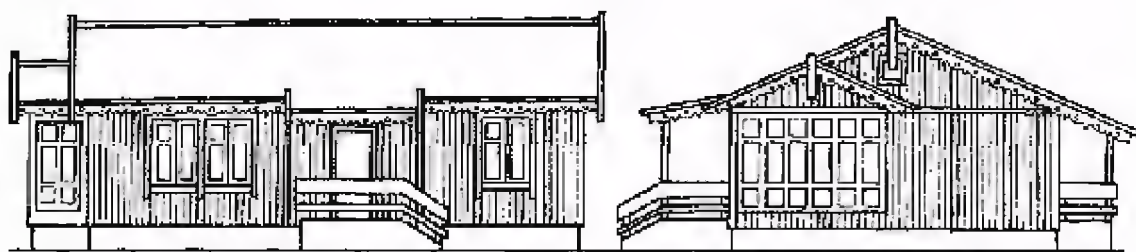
Варианты оформления фасада одноэтажного трехкомнатного жилого дома
